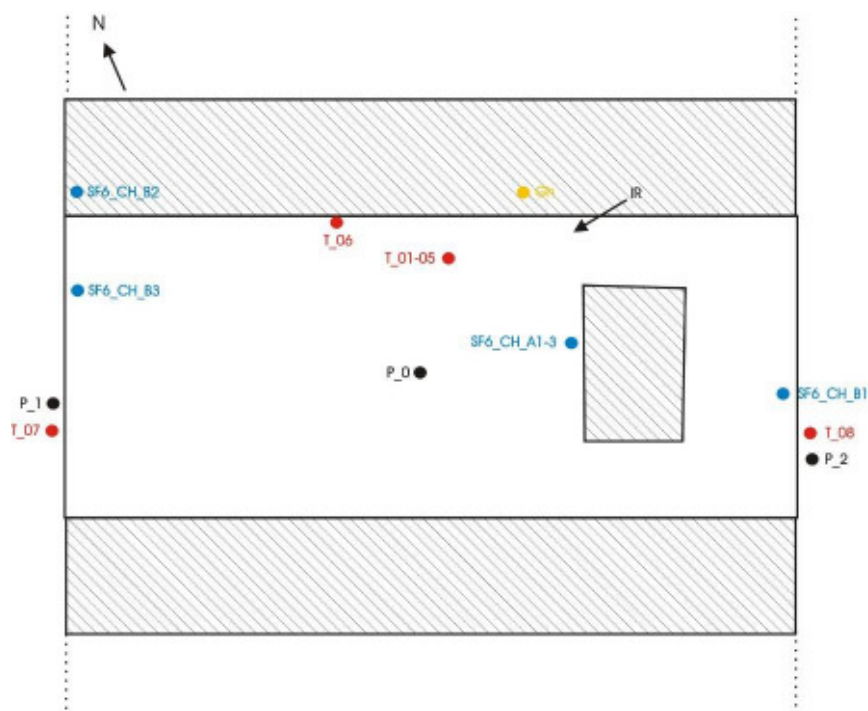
Lage der Messpunkte im Grundriss
